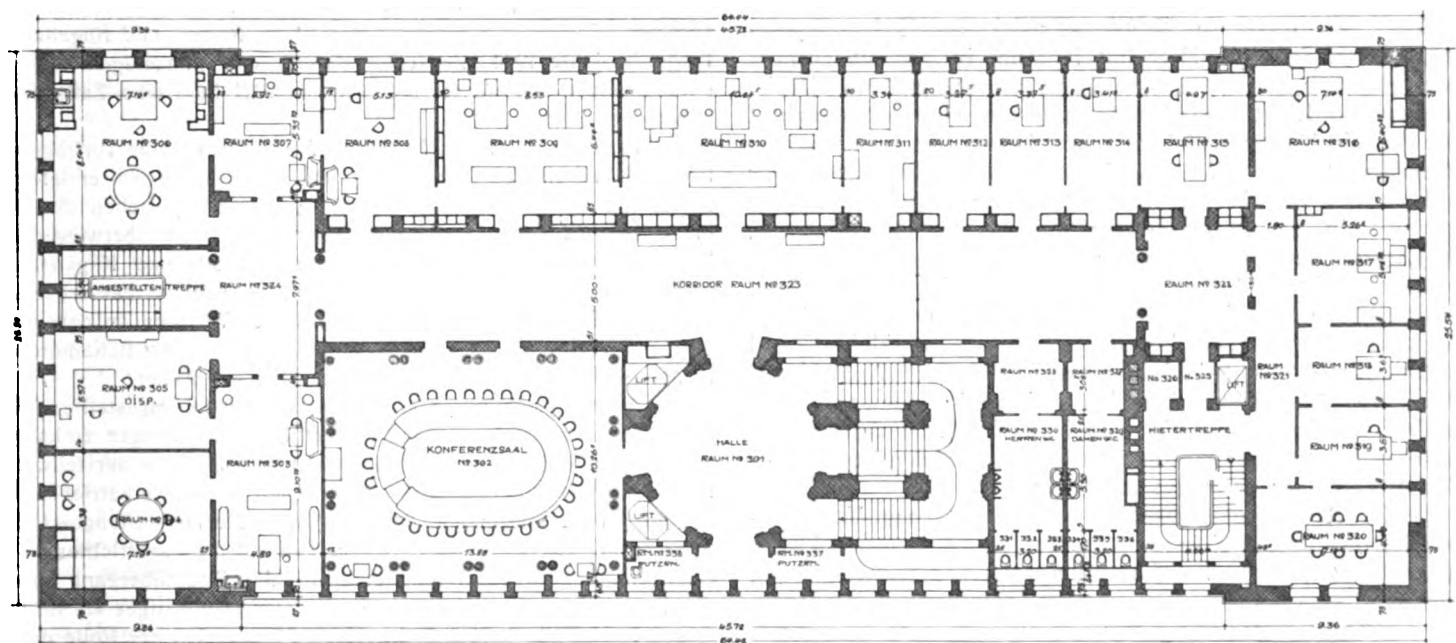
Grundriss vom III. Stock des Schweiz. Nationalbank-Gebäudes in Zürich. — Masstab 1:350.
